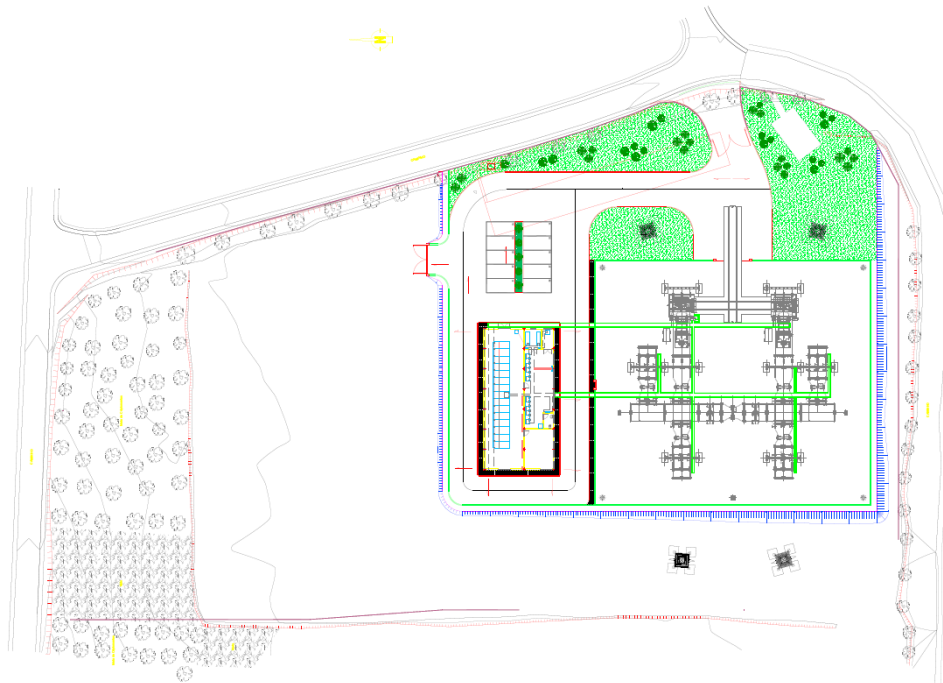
Esboço da Planta do Projeto de Construção da Subestação 60/30 kV de Ponta Garça
